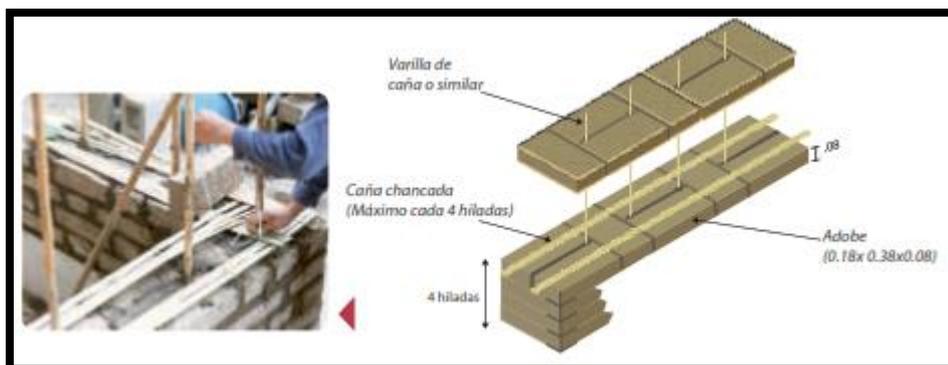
Muro reforzado con caña o similar, vertical y horizontal
